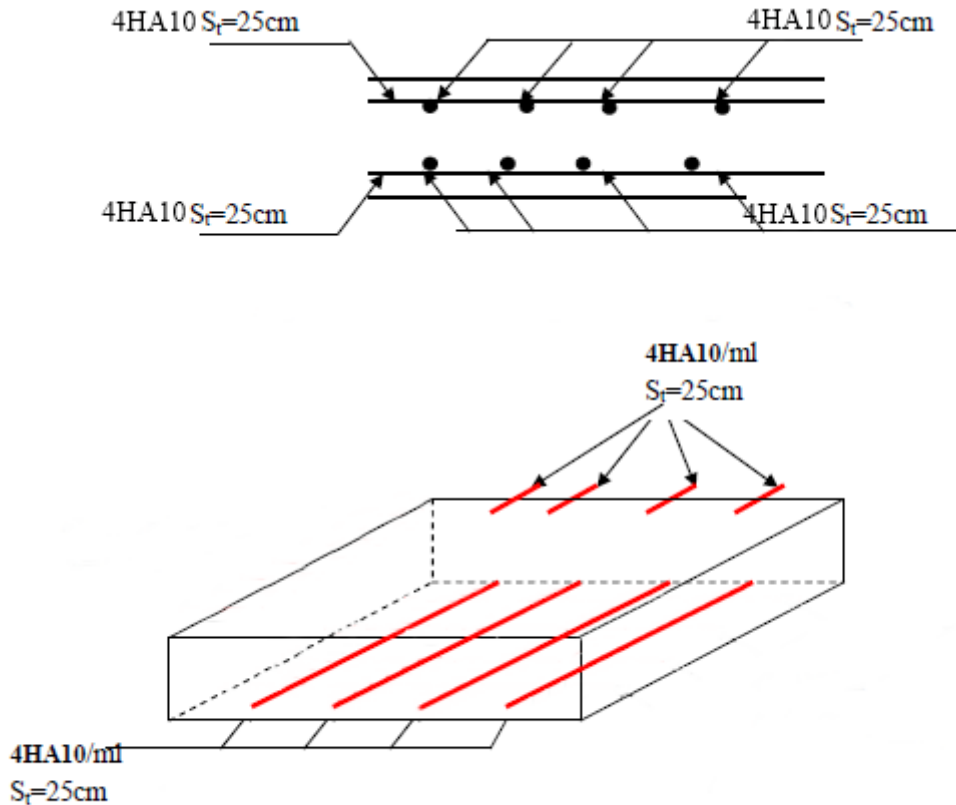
Dessin du ferrailage de la dalle du balcon type 3
